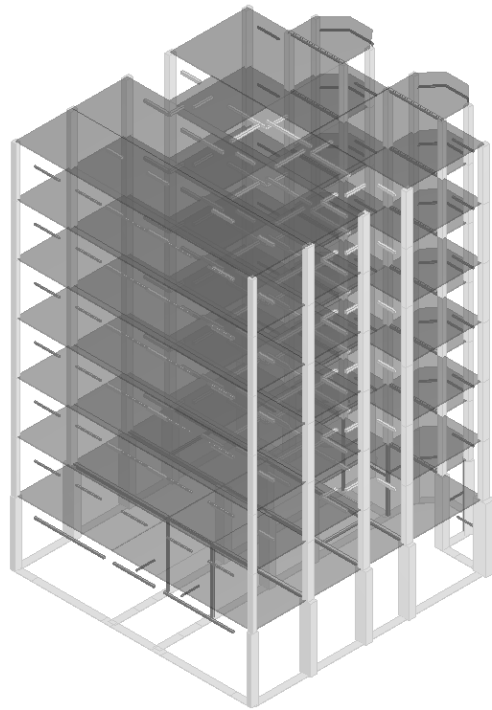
Vista en planta de plantas tipo del edificio ED-02 (fuente: elaborado por el autor)
